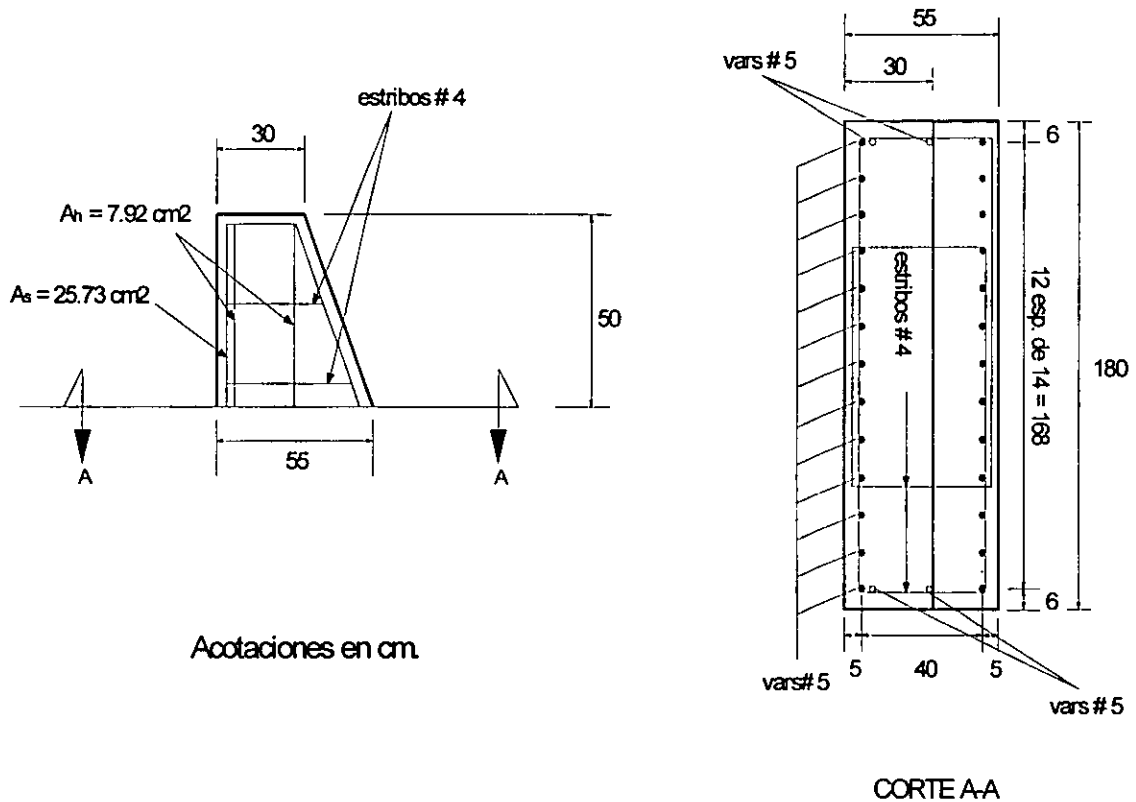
Geometría y distribución original del acero de refuerzo de los topes laterales del puente Nexpa
